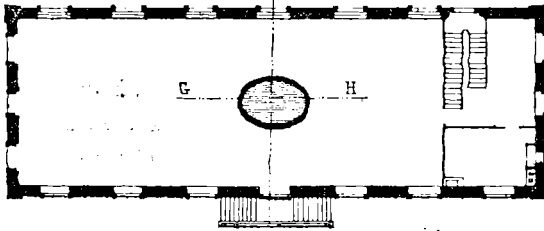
Plans des bâtiments du laboratoire Arago.
